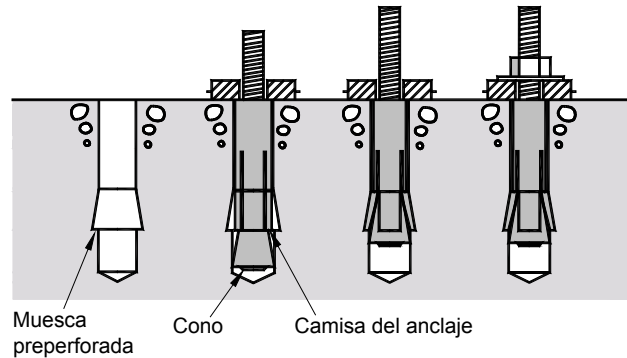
(c) – Anclaje rebajado Tipo 3: Anclaje de desplazamiento controlado que se instala en una muesca rebajada preperforada tirando del cono hacia arriba y provocando que la camisa se expanda hacia la muesca
